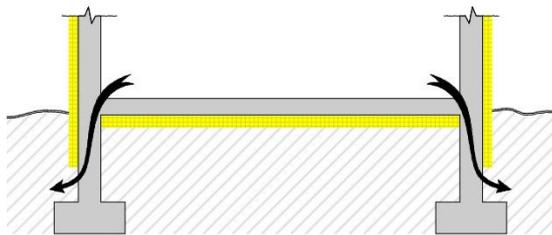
Plancher sur terre plein, prolongement de l'isolation extérieure en dessous du niveau du sol.
